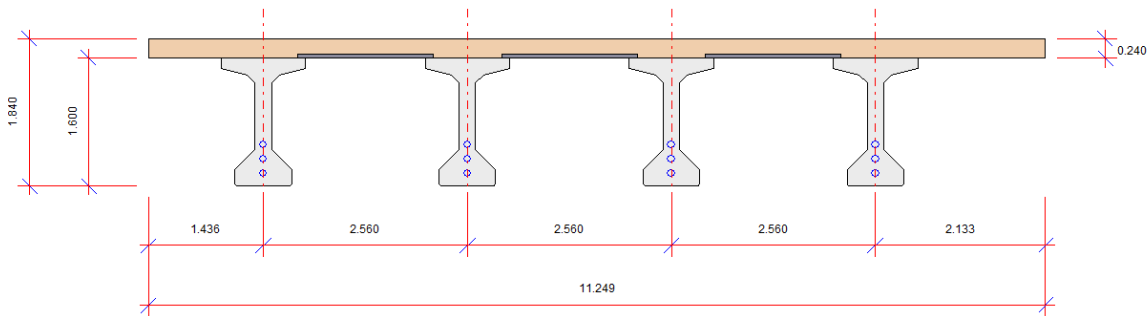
Sección tipo. Fuente: IDOM-DEHC.
